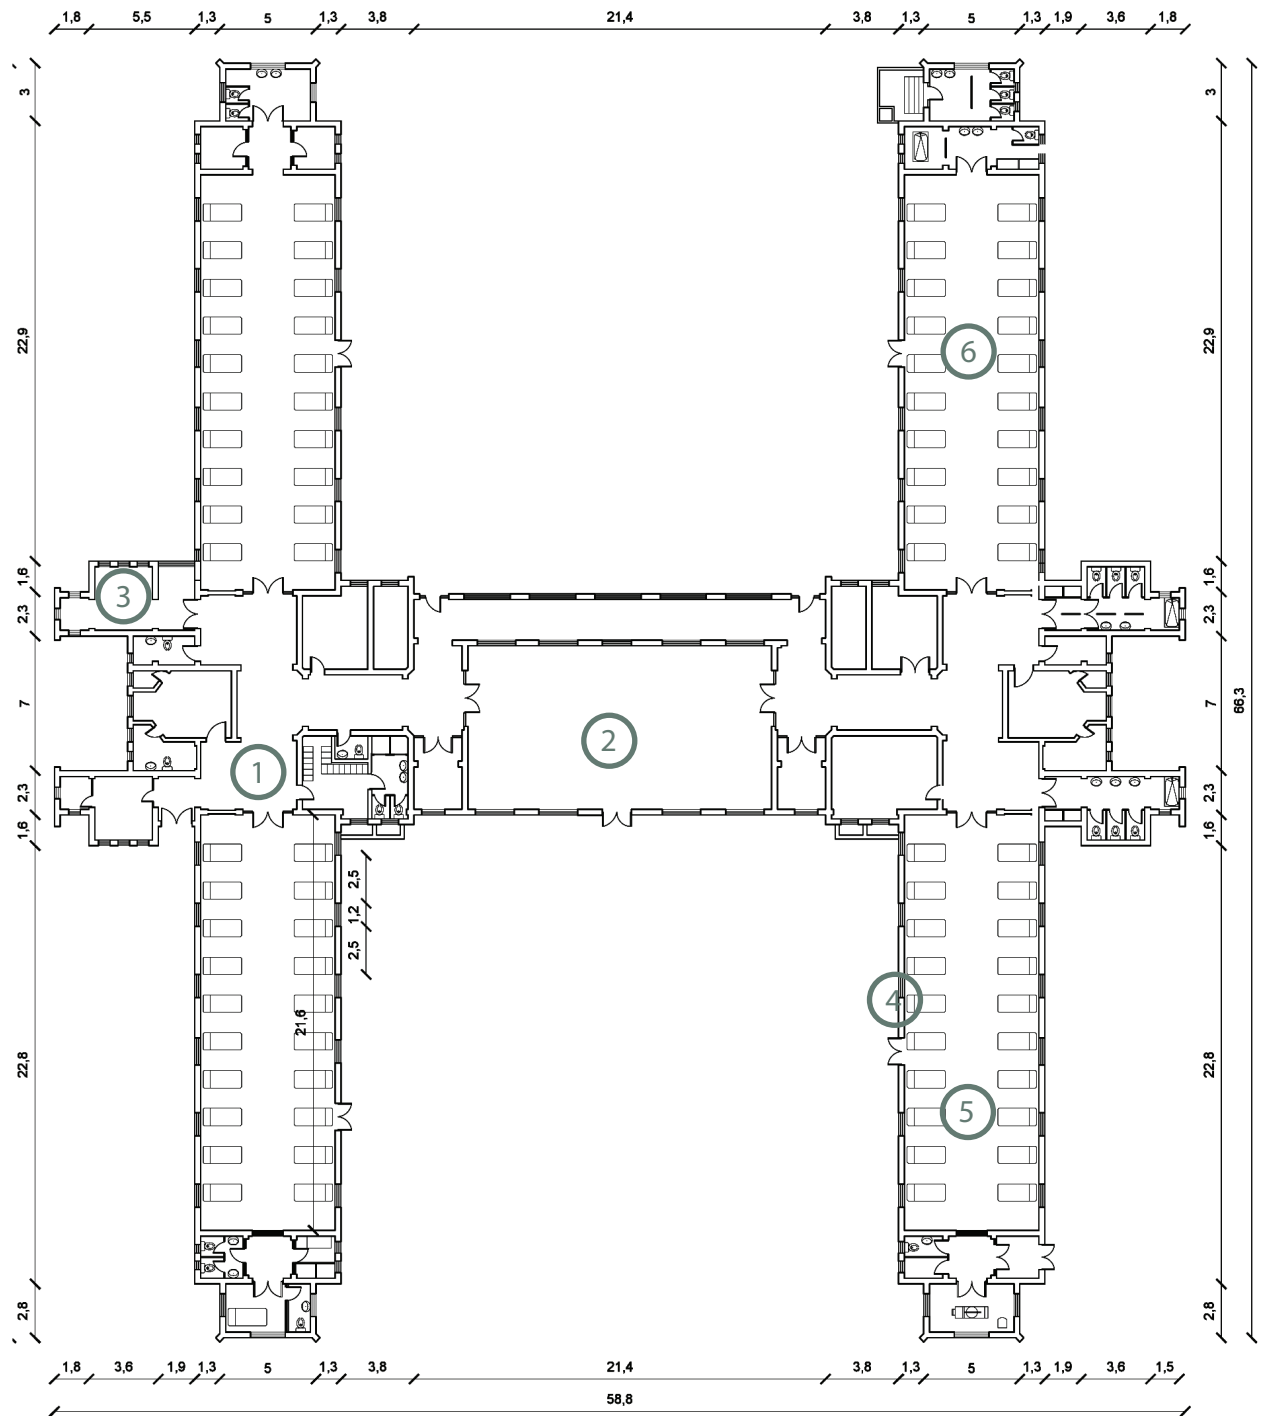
Planta General Pabellón 9, Localización de daños estructurales.
